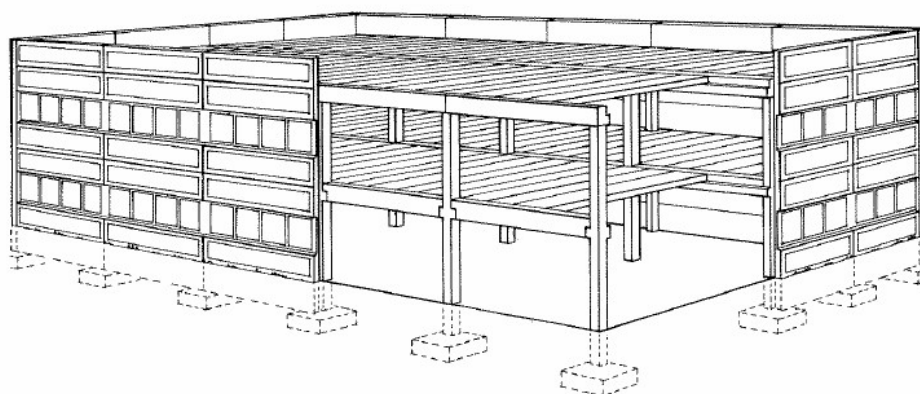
Painéis não estruturais de fachada (Acker, 2008)
